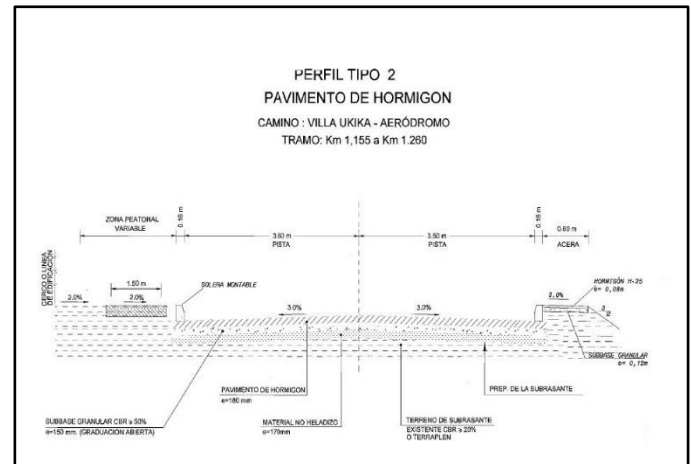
Perfil Tipo 2, Ancho de calzada de 7 metros.
